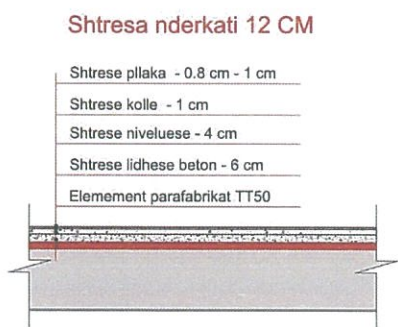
Detaj i shtresave në katin e parë dhe të dytë (ndërkartet)
